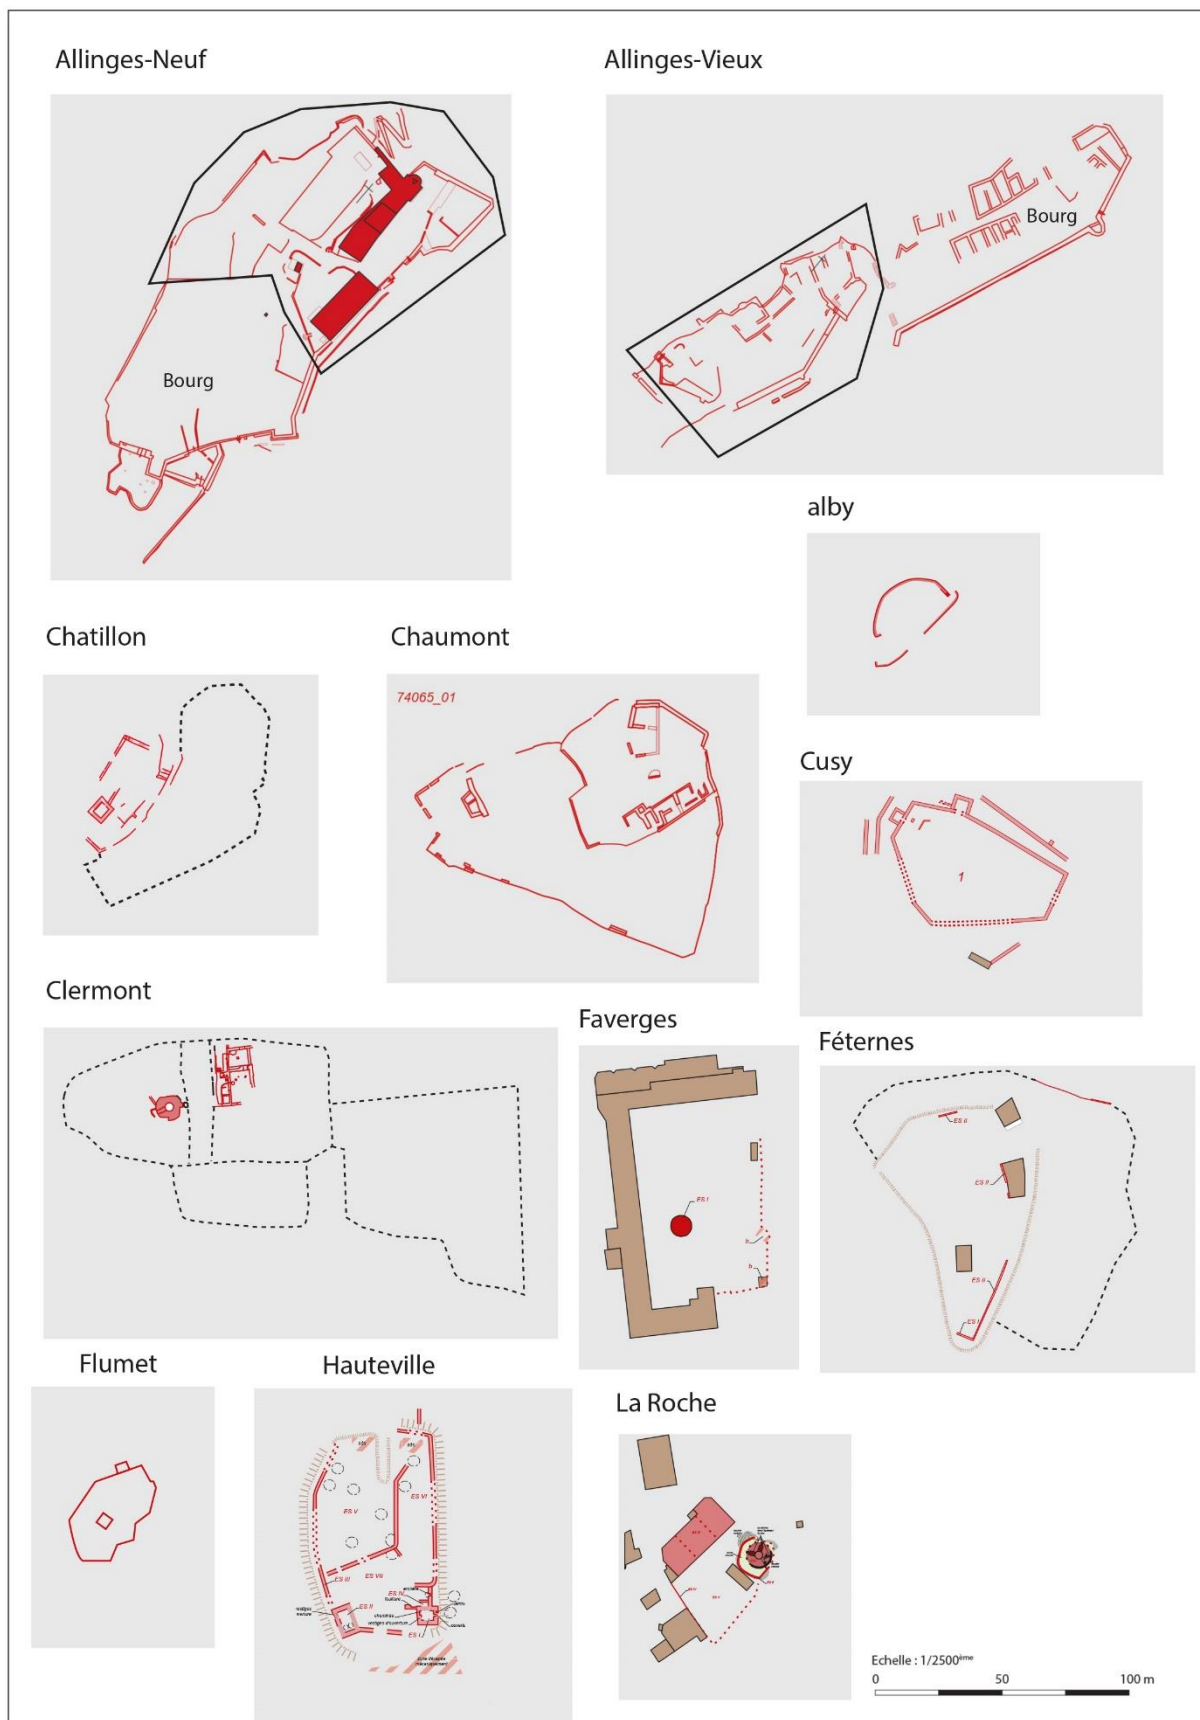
Châteaux à plans complexes. DAO : L. Benoit et M. Chevalier.
